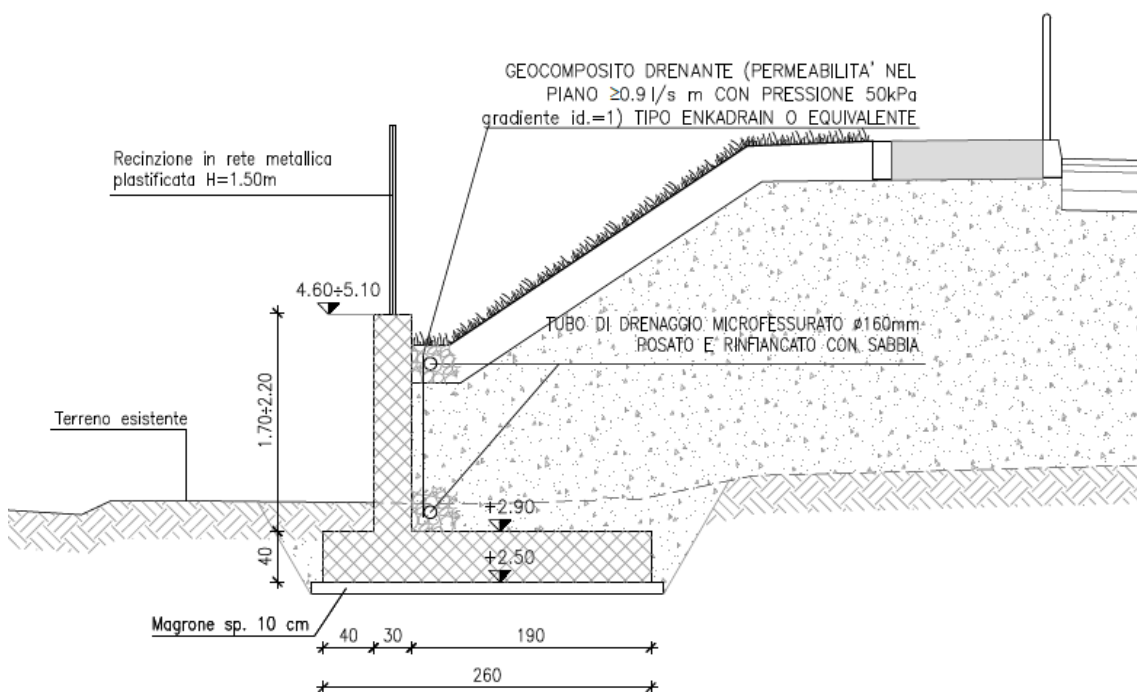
Muro di sostegno sud – Sezione trasversale
